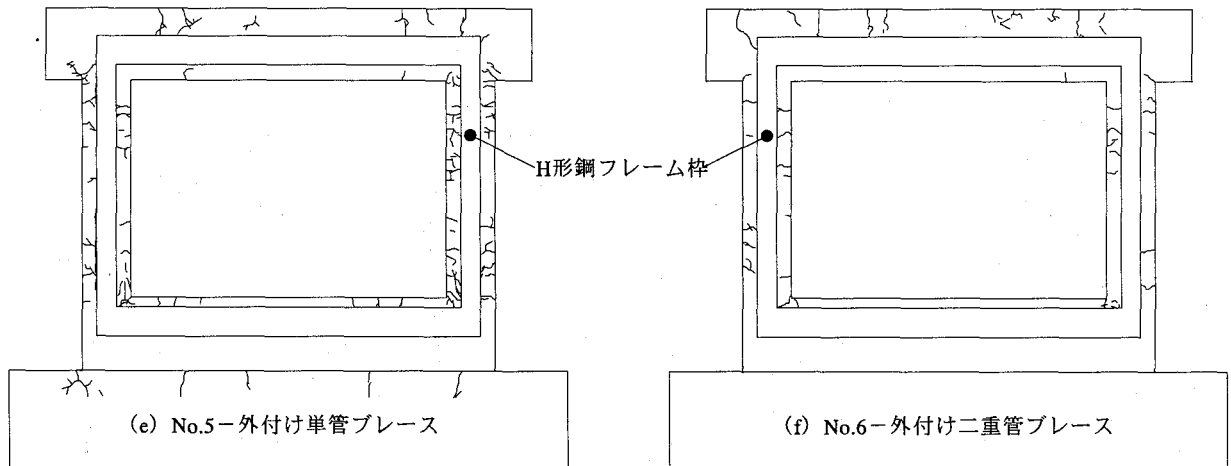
ひび割れ図 ($R=\pm 1.0\%$ 時) (3)
